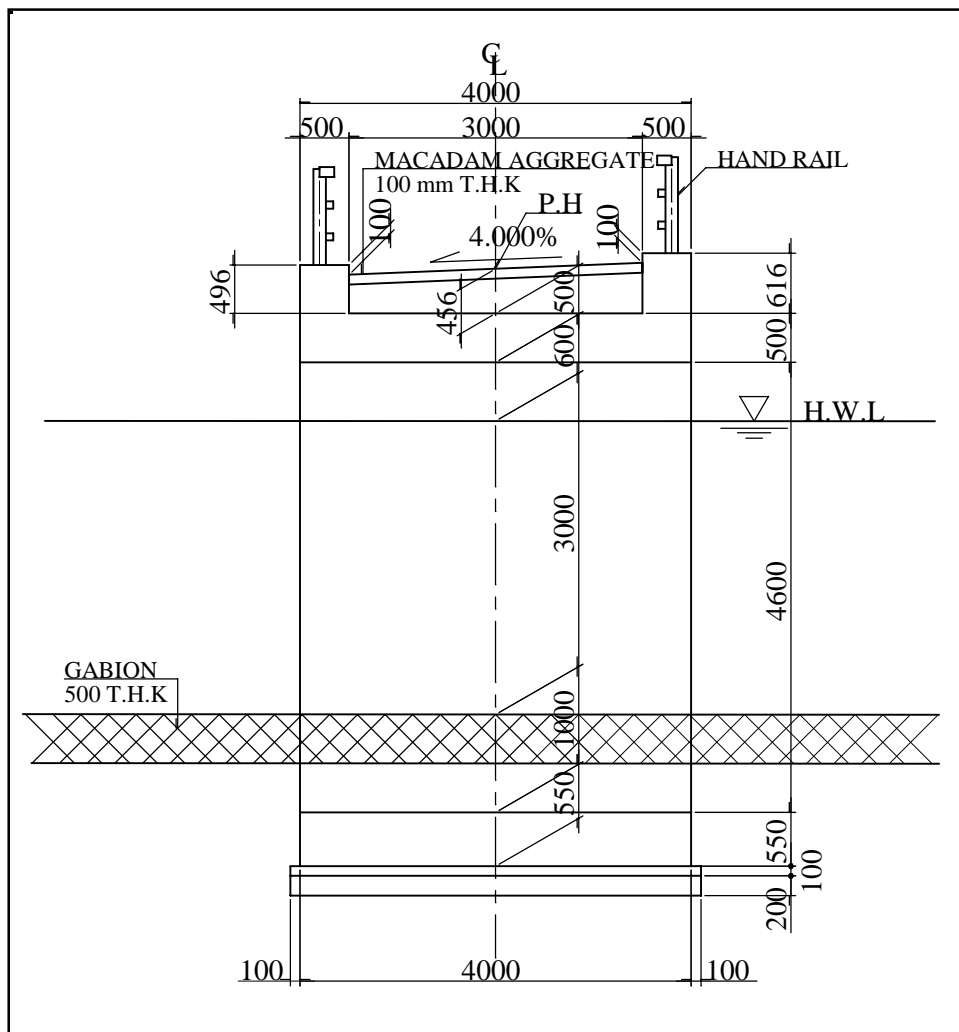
涵渠工案标准横断面图 (Bridge No.3)
